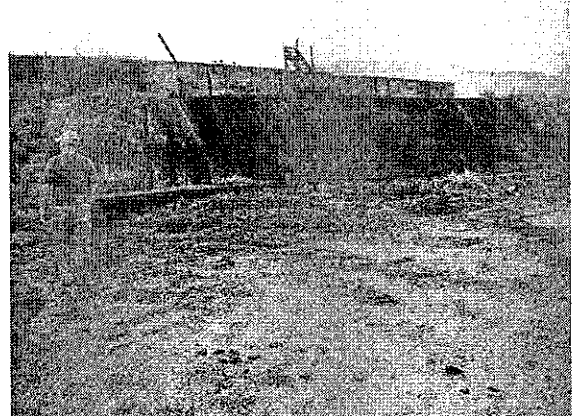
Lote 28/SC – Contorno de Araranguá.
